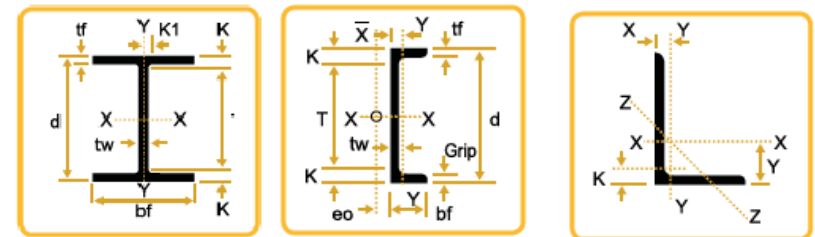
detalles de perfiles de acero IPR, CPS, y perfil angular
